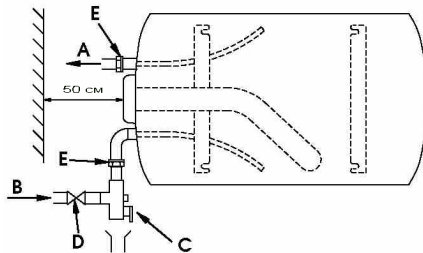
Установка предохранительного блока при горизонтальном монтаже — трубопроводы подводятся с левой стороны водонагревателя
